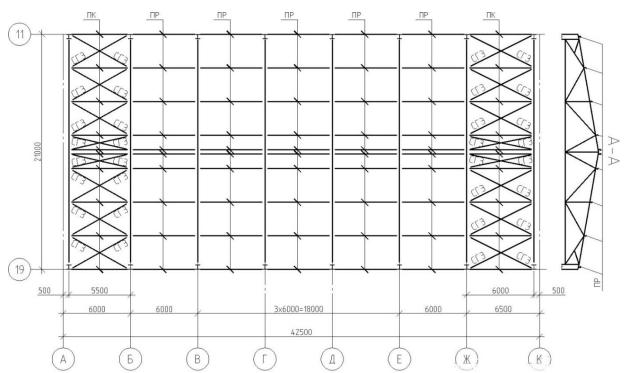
Схема расположения горизонтальных связей по верхним поясам ферм
